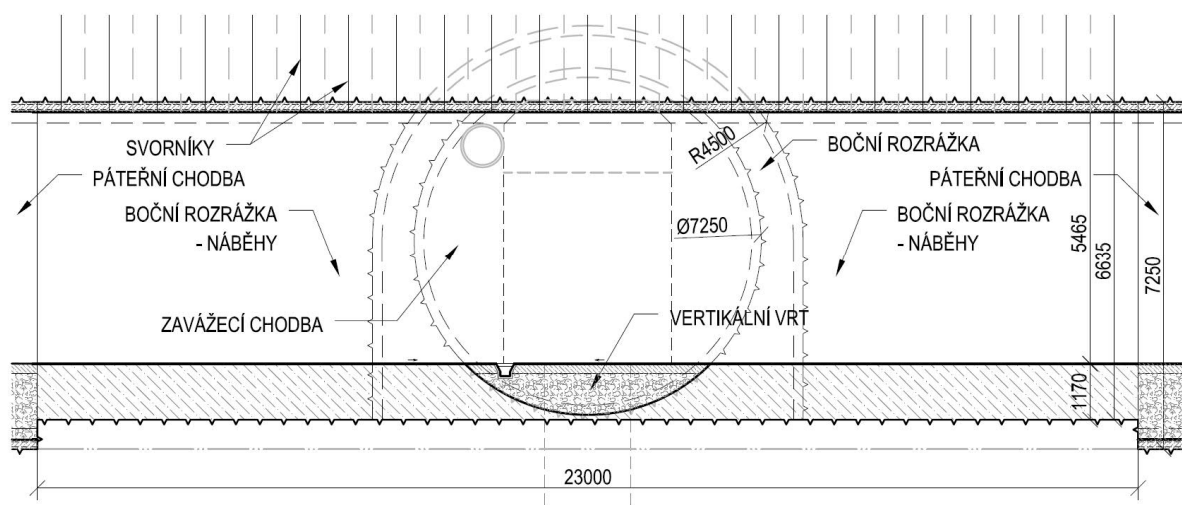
Půdorysné schéma ukládání – varianta D1
